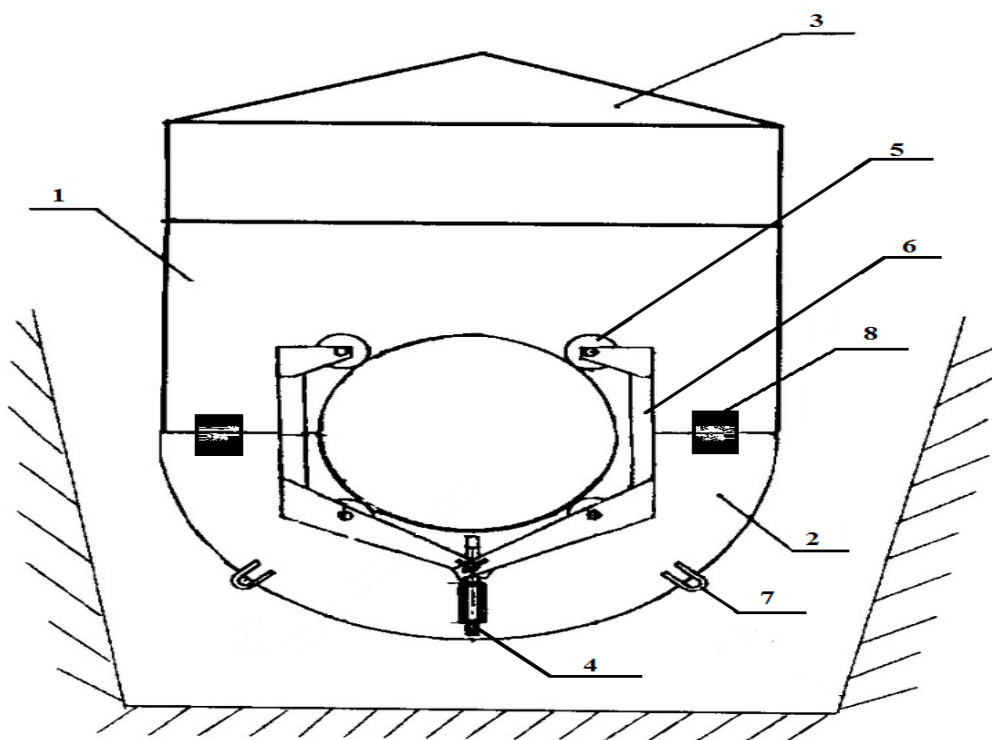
Камера ремонтная поворотная (вид с торца)
